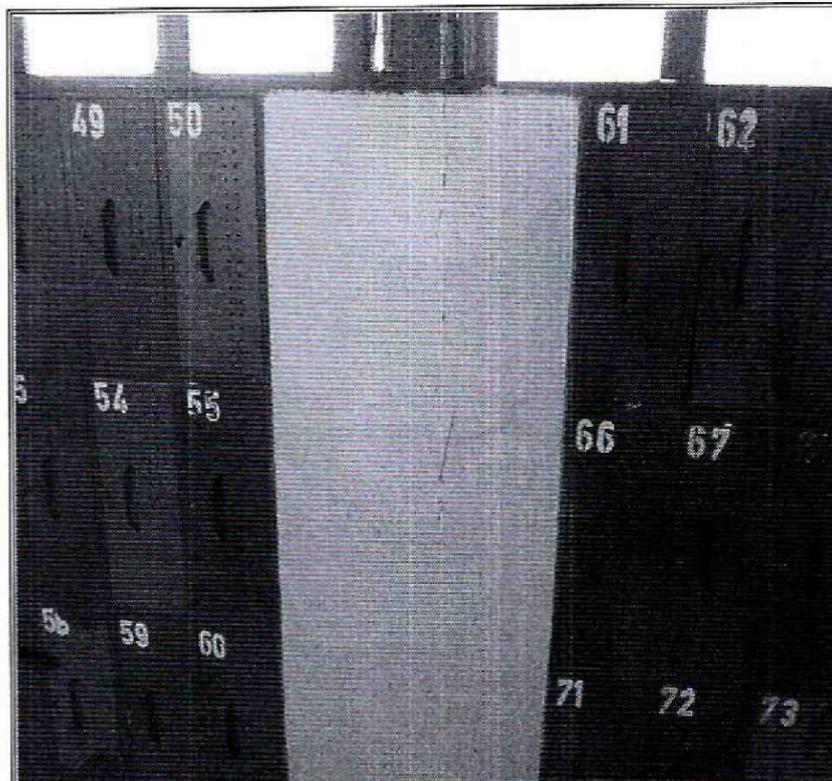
Fisuras tendencia vertical muros de cerramiento perimetral "La Casona"
